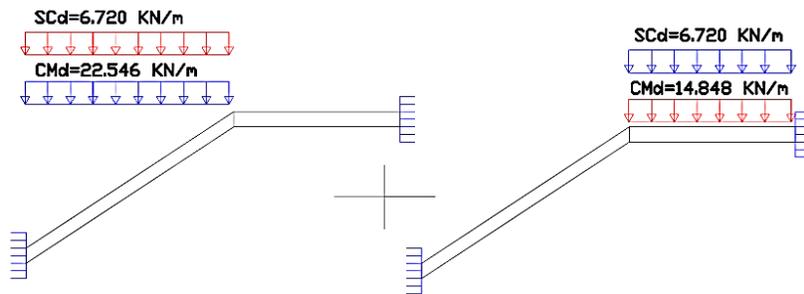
Consideración de la escalera para el cálculo de la armadura negativa.
